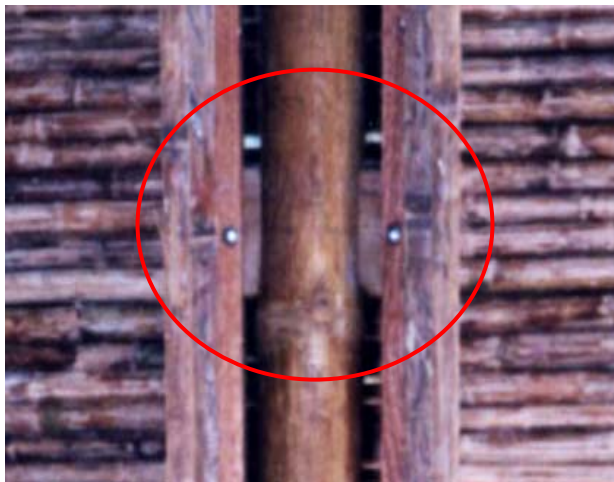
Detalhe de encaixe dos painéis ao pilar de bambu, através de um tarugo de madeira que traspassa o pilar e parafusa-se aos painéis.
